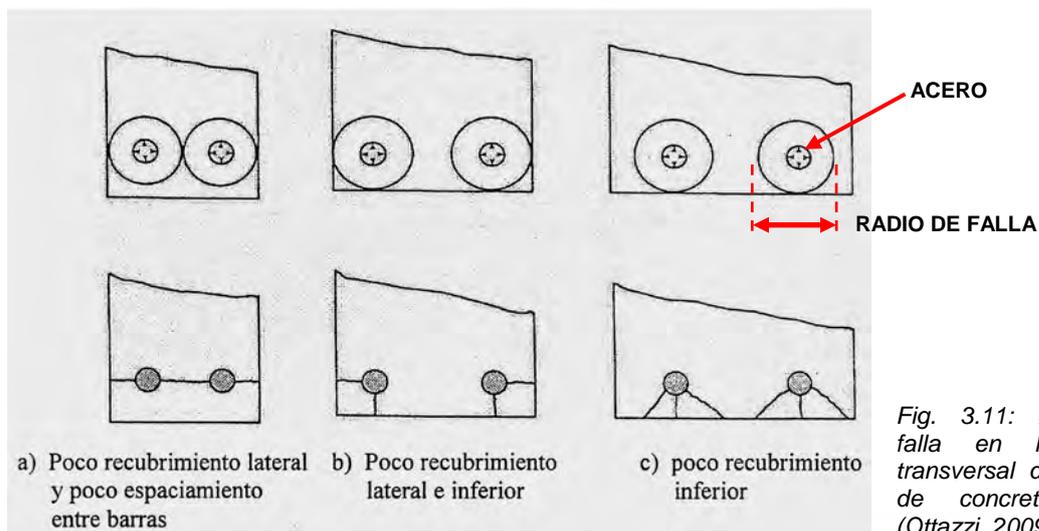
Formas de falla en la sección transversal de una viga de concreto armado (Ottazzi, 2009).
